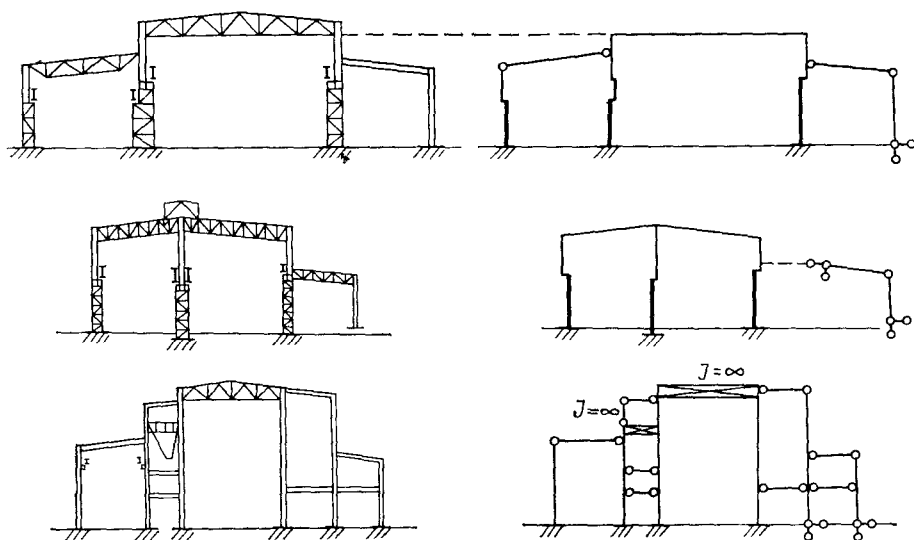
Варианты схем каркасов промышленных зданий с выделенной в расчетной схеме основной жесткой рамой
